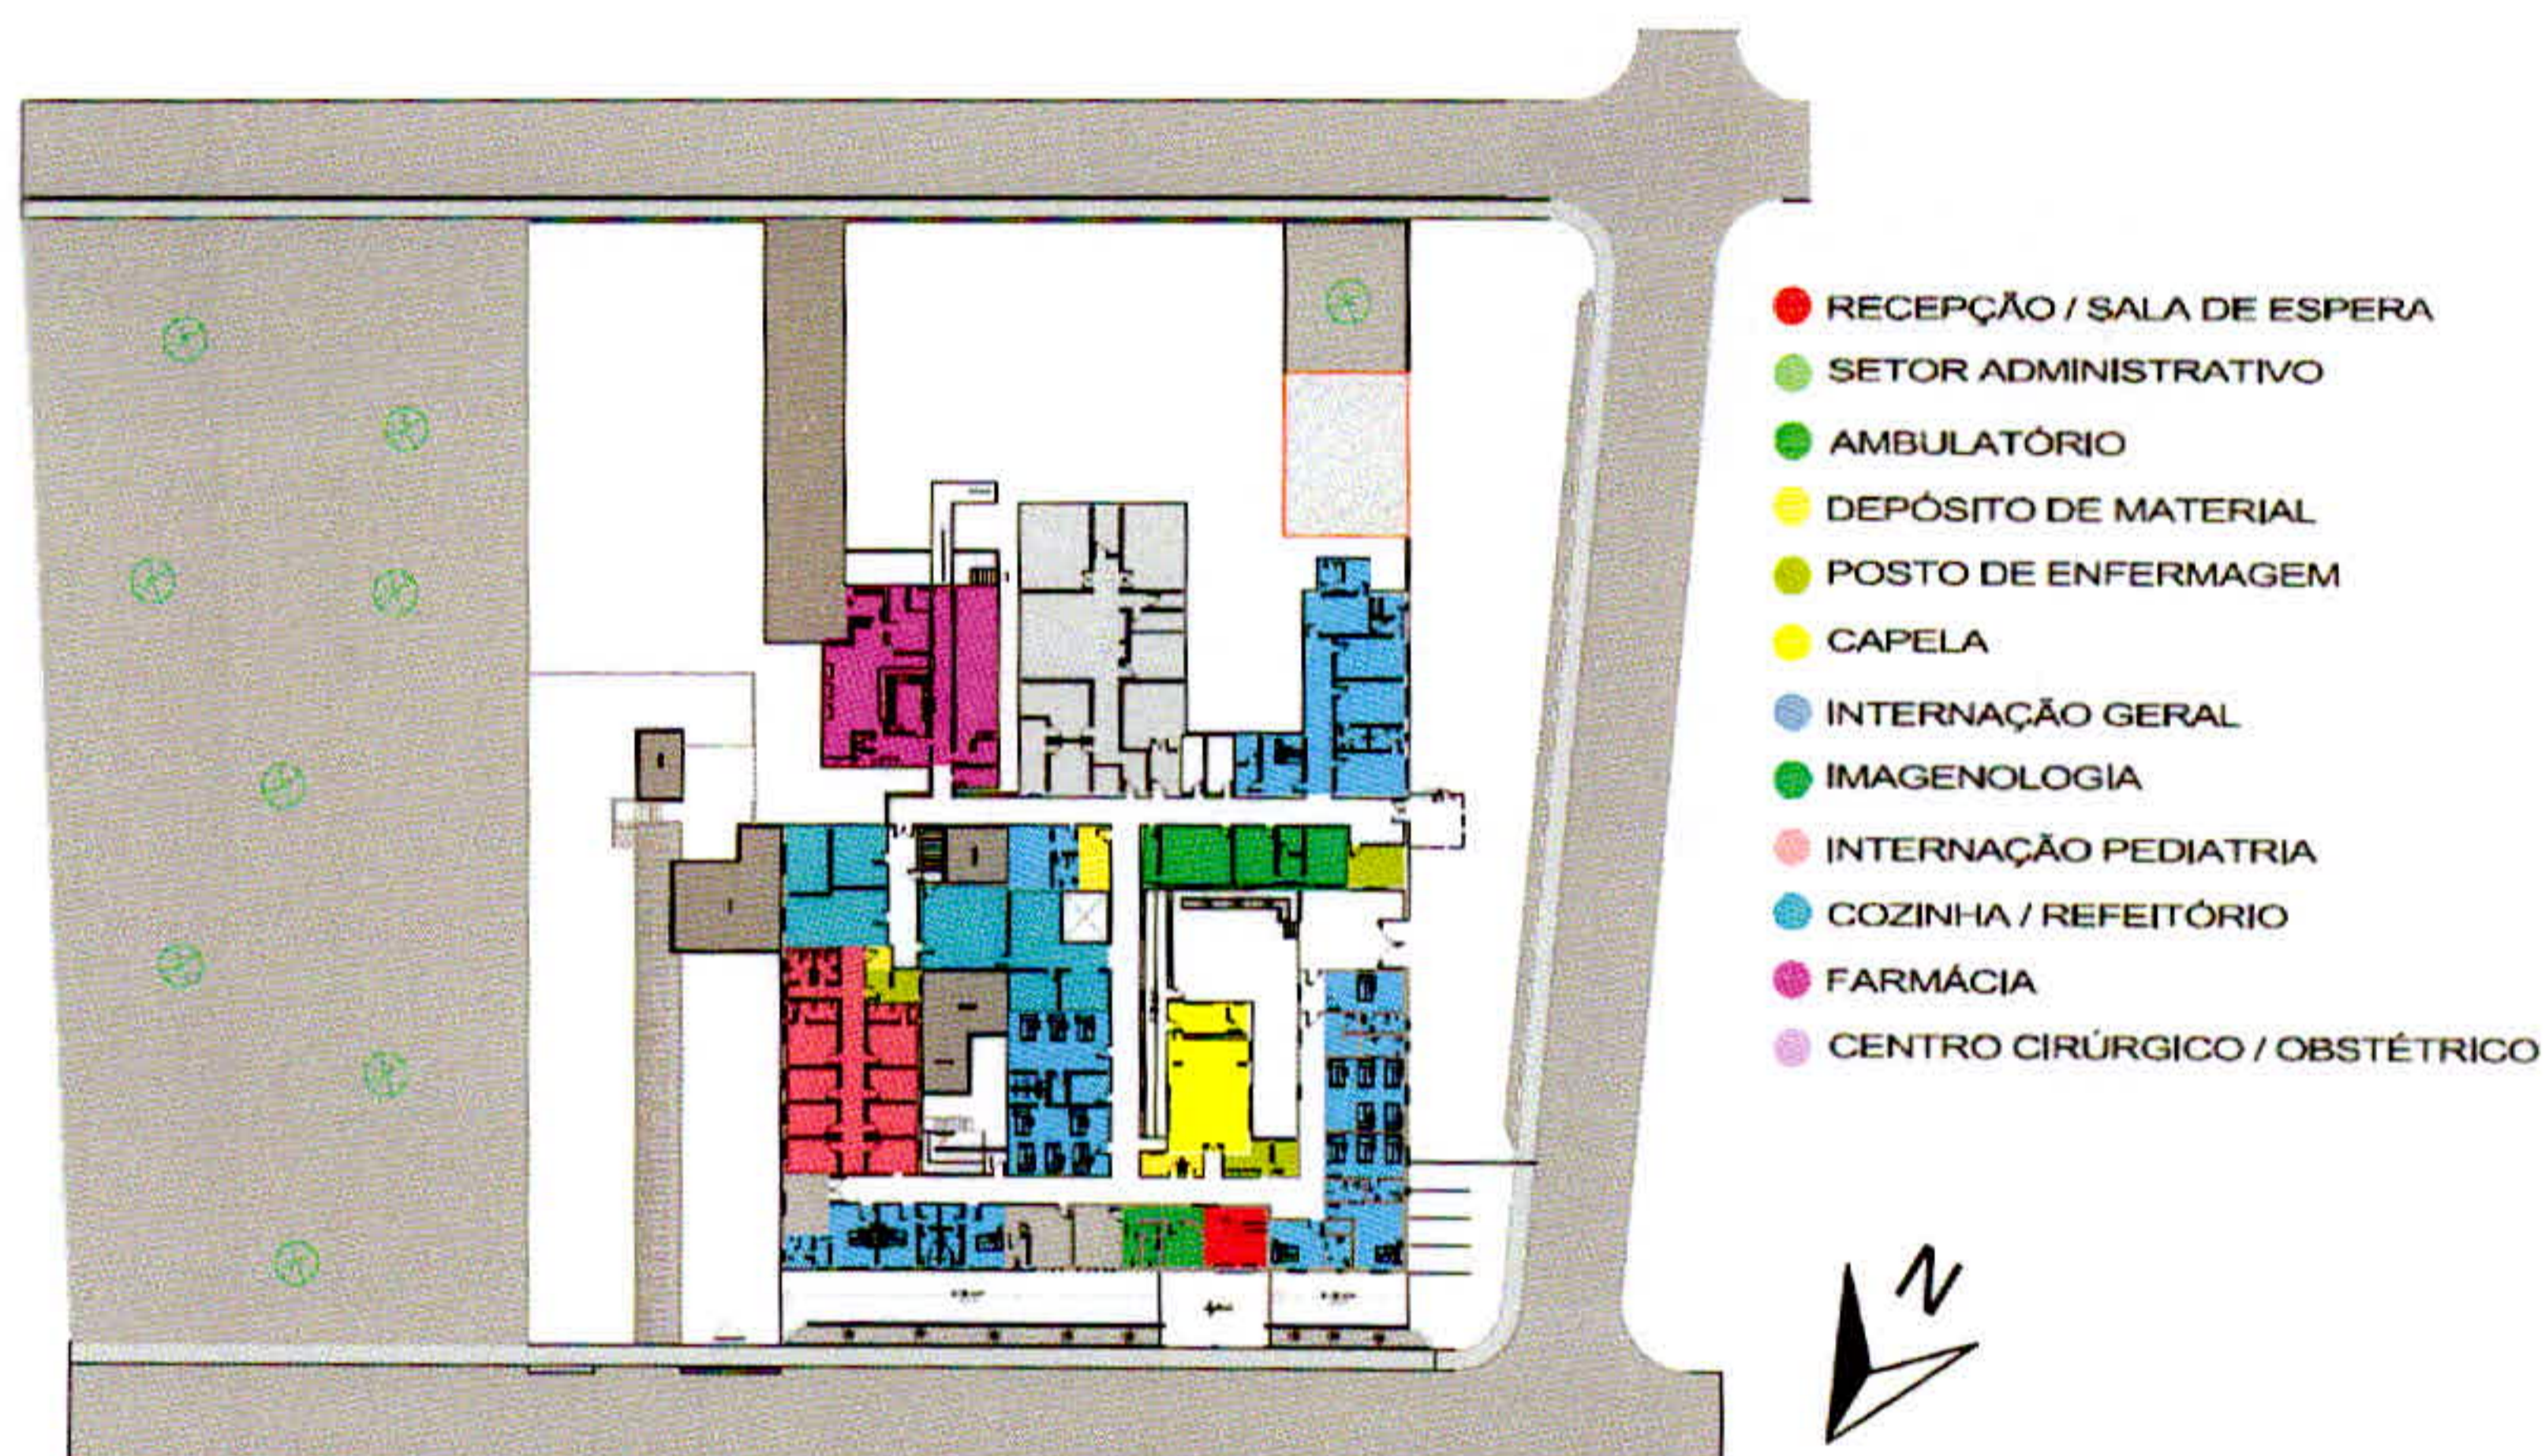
Planta pavimento térreo com demarcação dos respectivos setores. Sem escala (ver Apêndice B).
